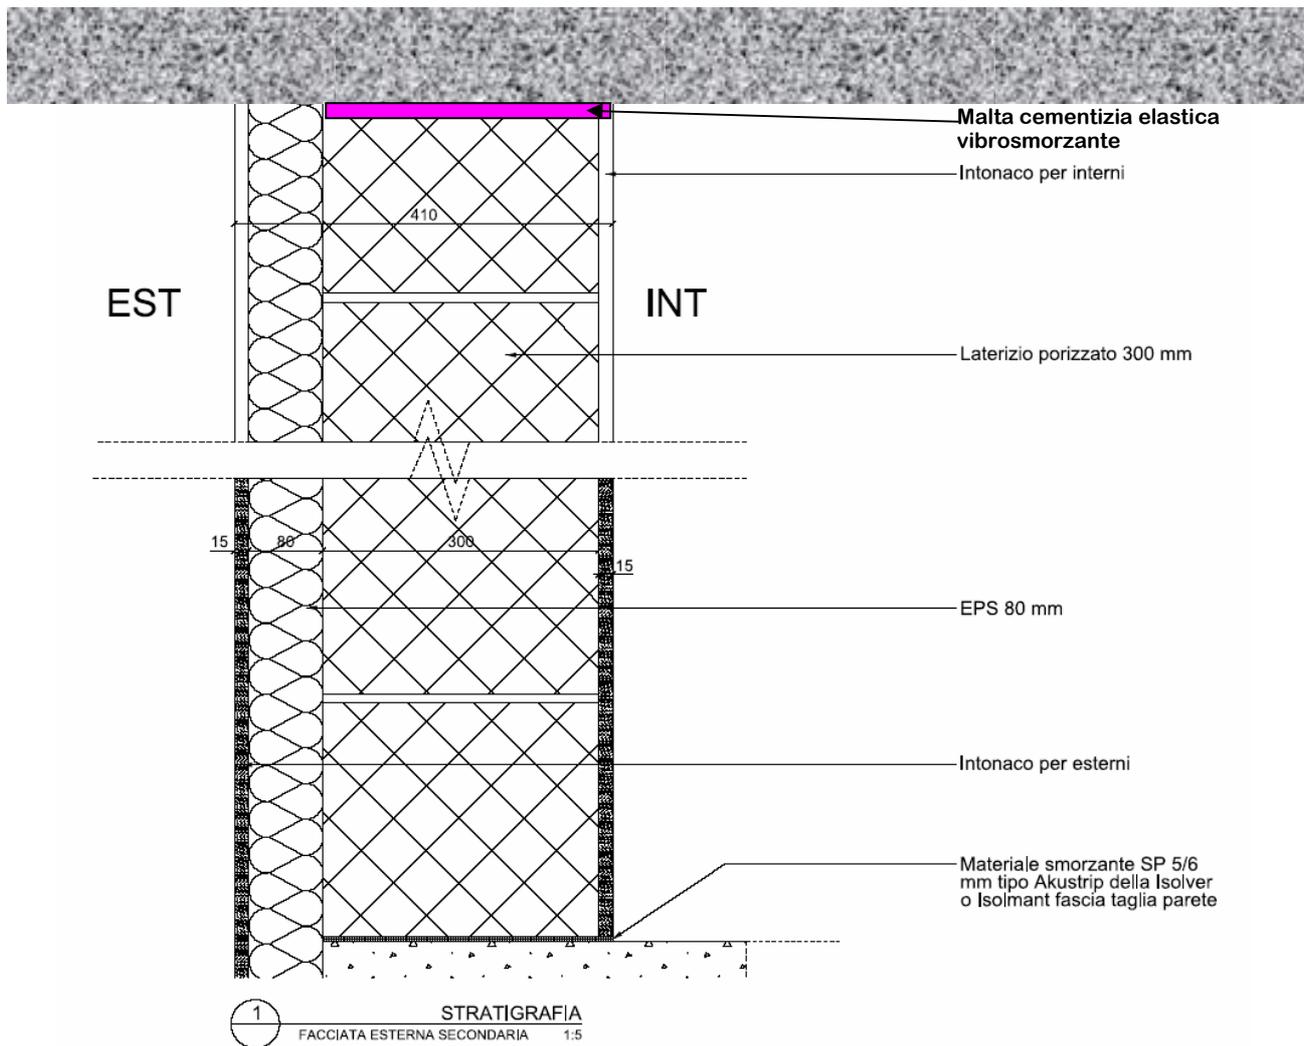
Sezione verticale della parete di facciata esterna secondaria
